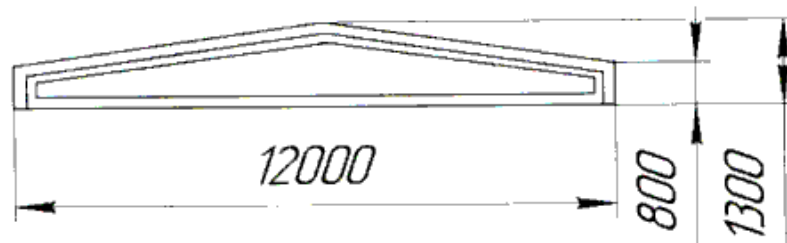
Железобетонная ферма серии 1.462-3
